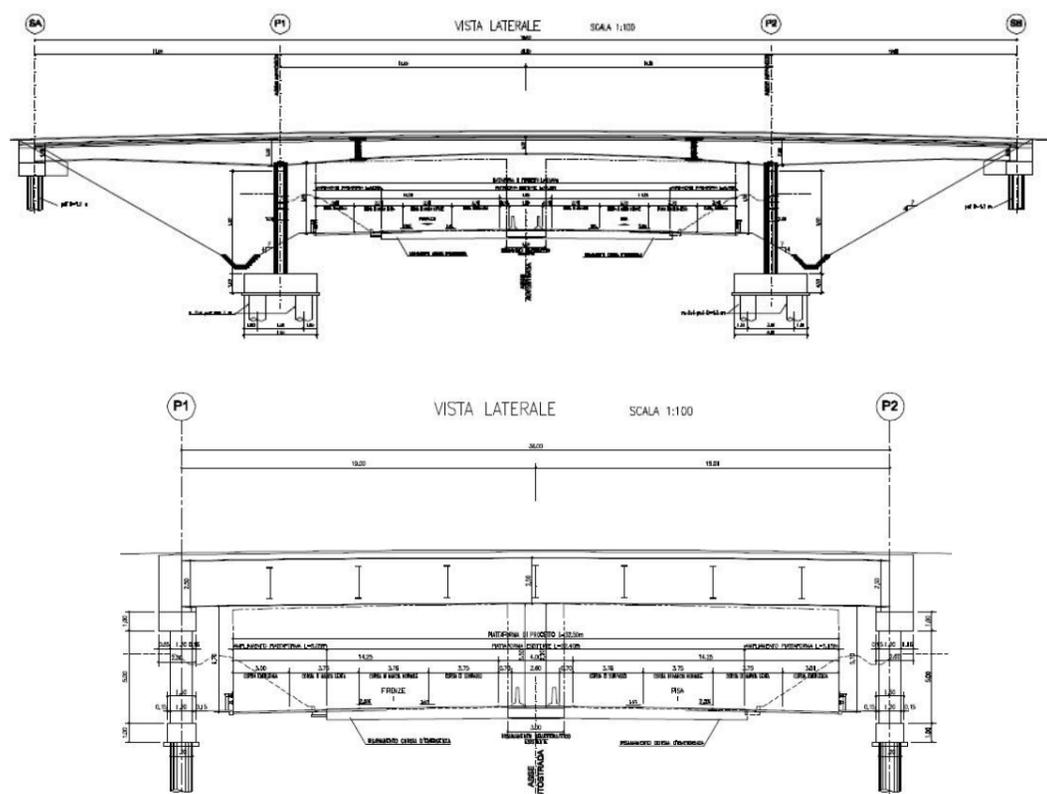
Vista laterale cavalcavia a una e tre luci e sezione del cavalcavia
